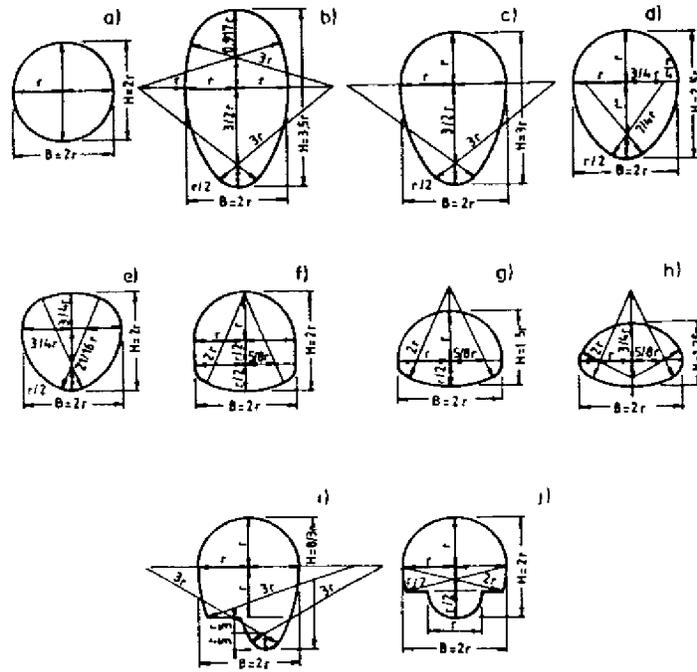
13: Formas de sección transversal para perfiles cerrados y sus correspondientes parámetros geométricos
